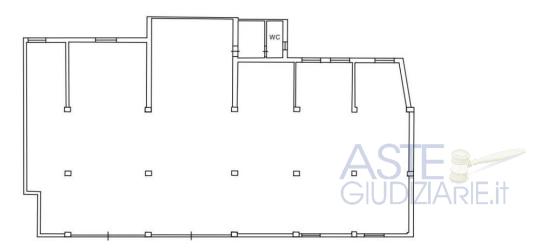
CESPITE 4: Planimetria stato di fatto e indicazione difformità rispetto ai titoli autorizzativi.
